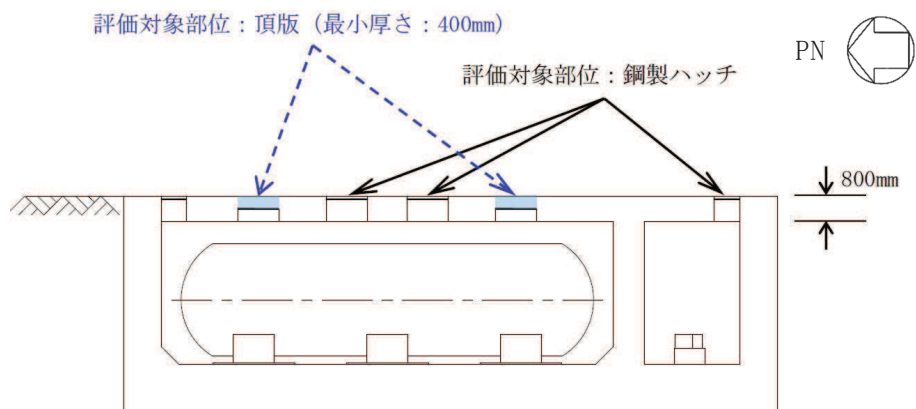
軽油タンク室の概略断面図 (A-A' 断面)
